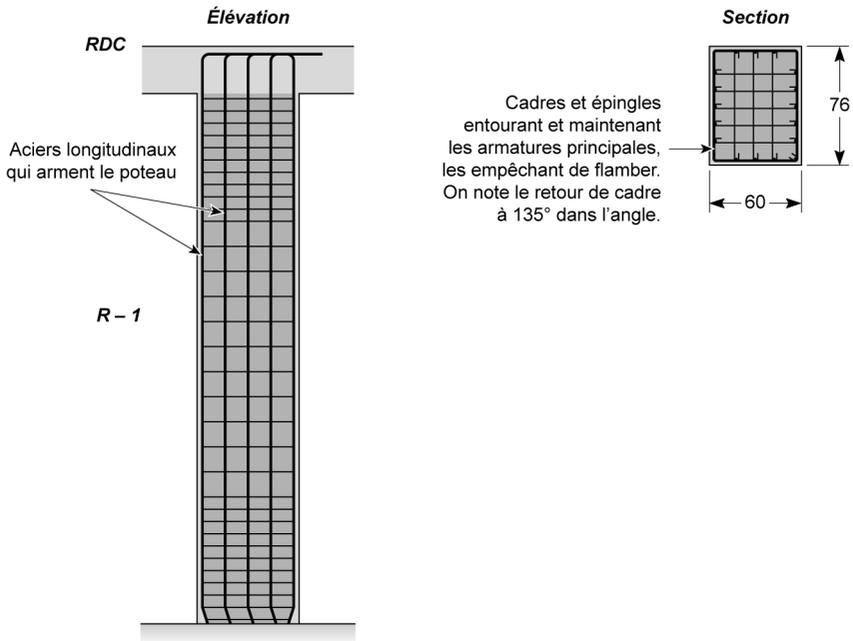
Exemple de ferrailage d'un poteau – élévation/coupe
